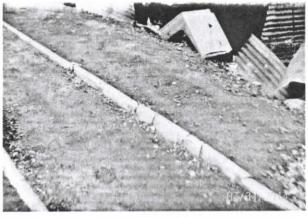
Murete de hormigón en ejecución en el tramo entre Grecia y Las Parcelas.
